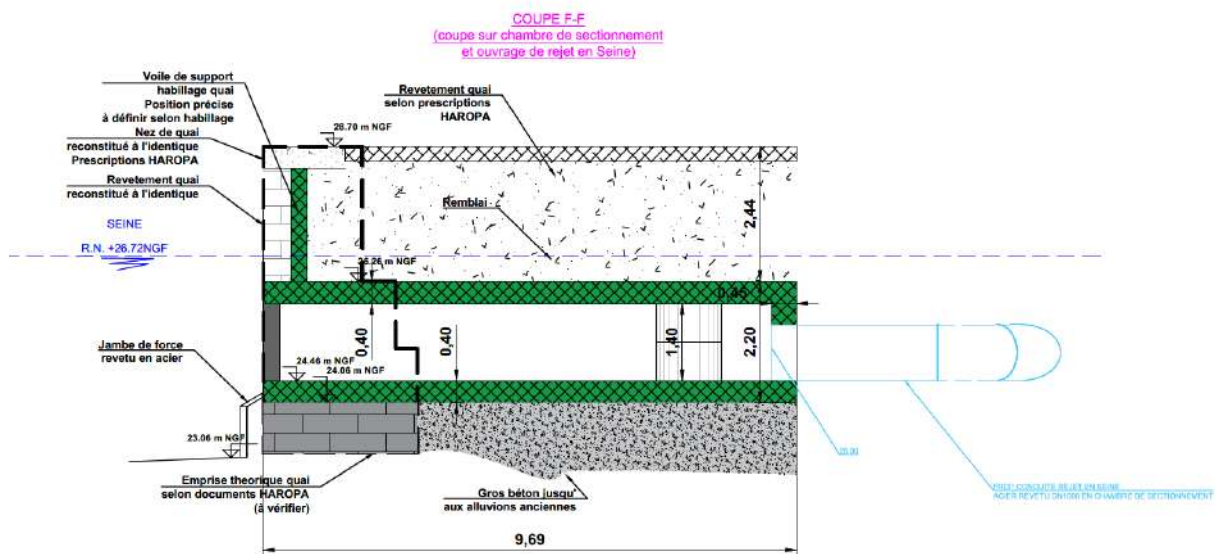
COUPE DE L'OUVRAGE DE REJET EN SEINE
